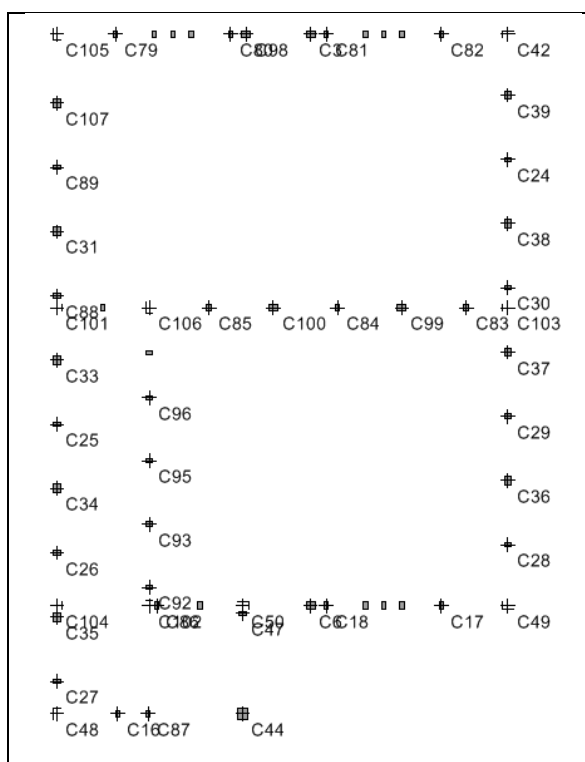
Distribución de pies derechos en V3 (planta 2).
